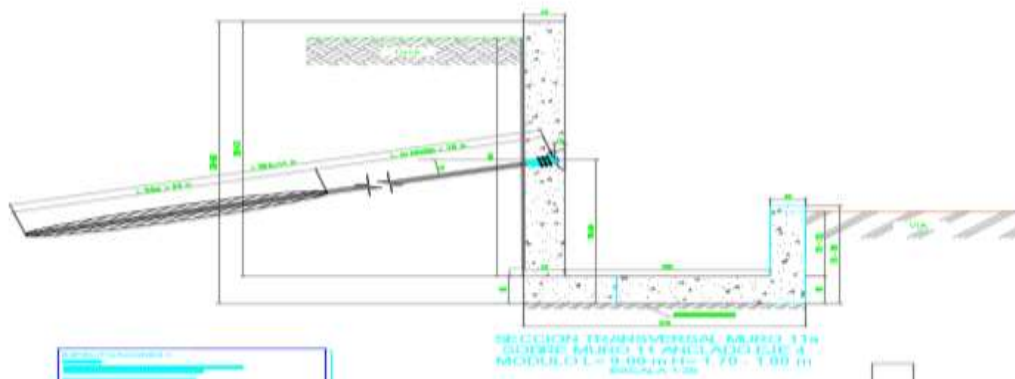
Planos muro anclado 11 alto viento, fuente propia.
